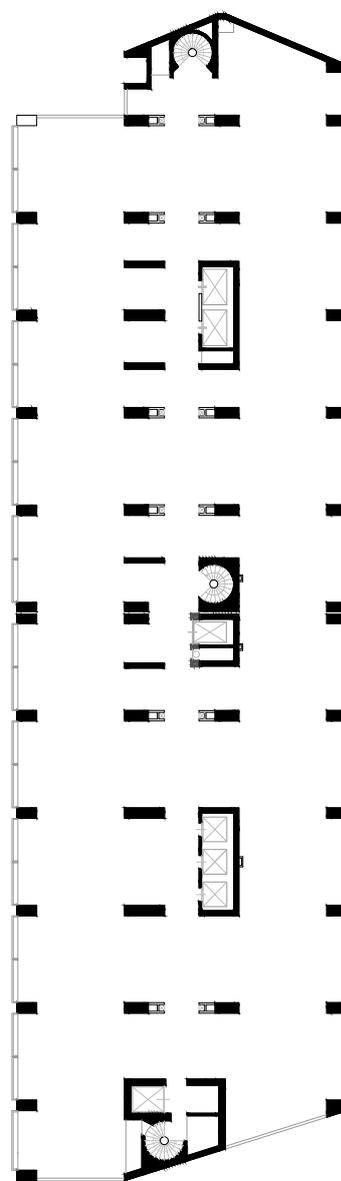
Planta estrutural assumida, com algumas diferenças nas caixas de elevadores retiradas
